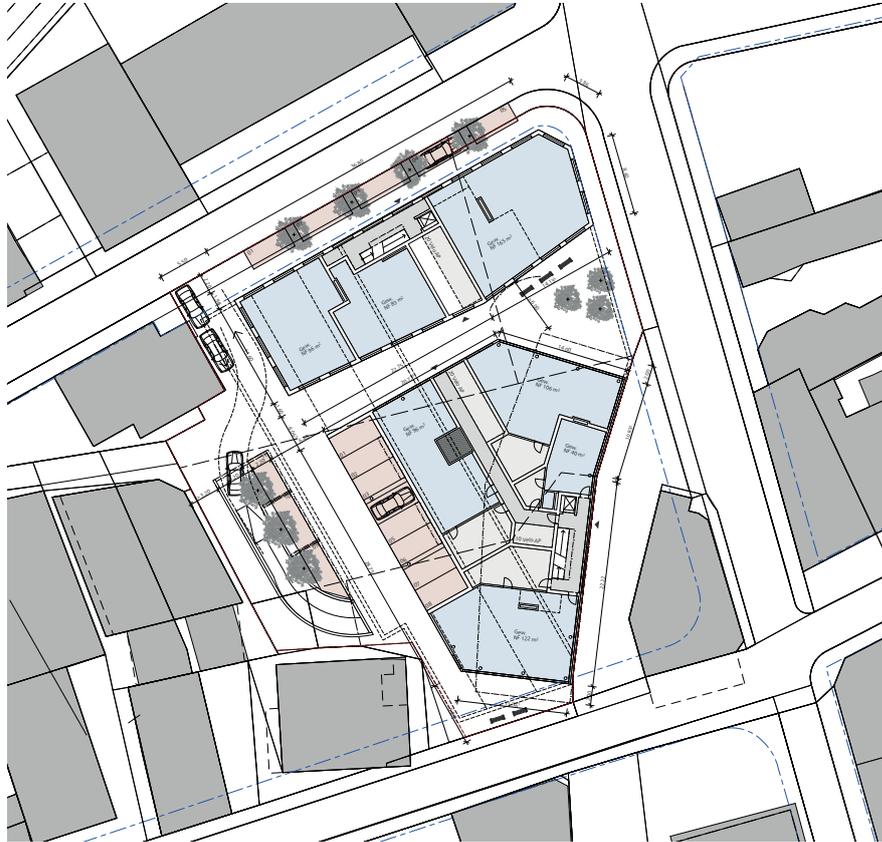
Erdgeschoss mit Gewerbenutzung und öffentlich zugängliche Aussenräume auf Strassenniveau mit öffentlichen Parkplätzen
